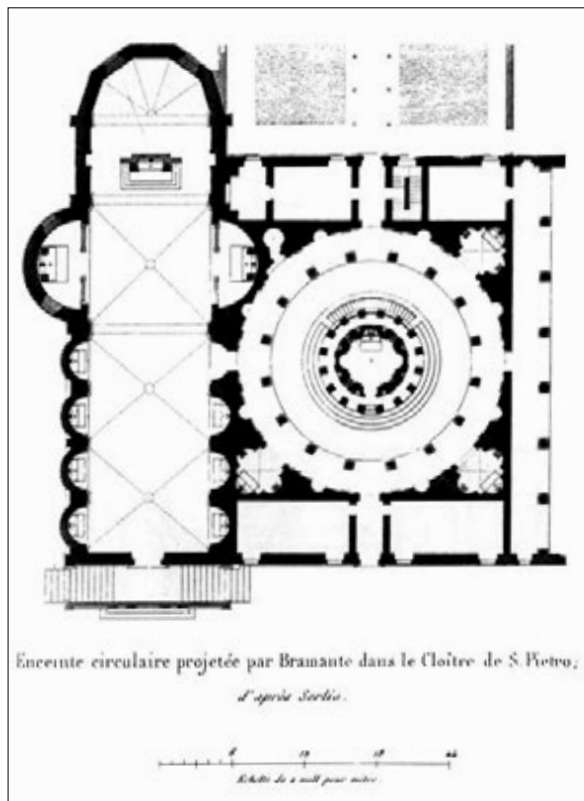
Paul Letarouilly, pianta regolarizzata della chiesa e ricostruzione del chiostro con il Tempietto secondo il progetto di Bramante (LETAROUILLY 1857, tav. 322, particolare)
